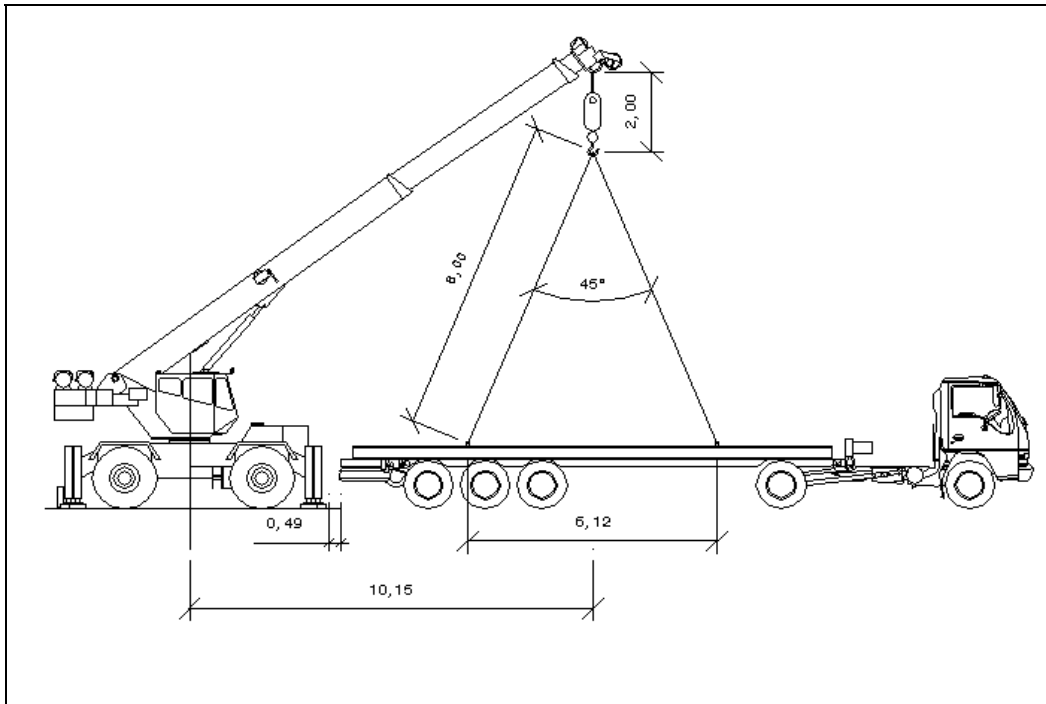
Corte com o posicionamento do guindaste e carreta para a movimentação de carga nos lotes 33 a 47.
